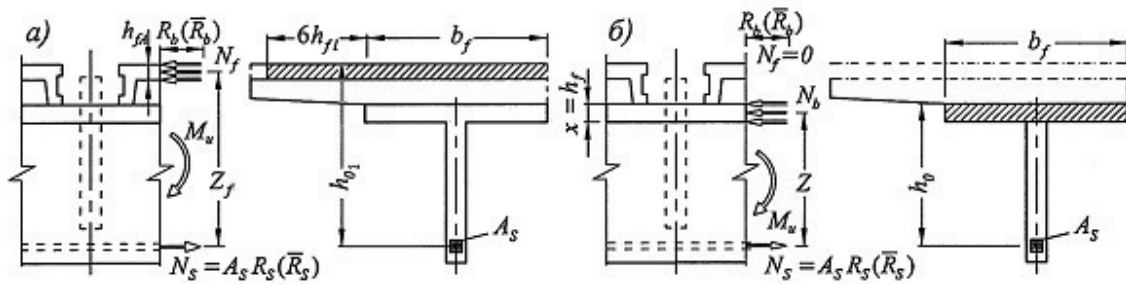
Розрахункові схеми поперечного перерізу крайньої балки за умов спільної роботи з накладною плитою (а) та у разі виключення її з роботи внаслідок провалювання (б).
